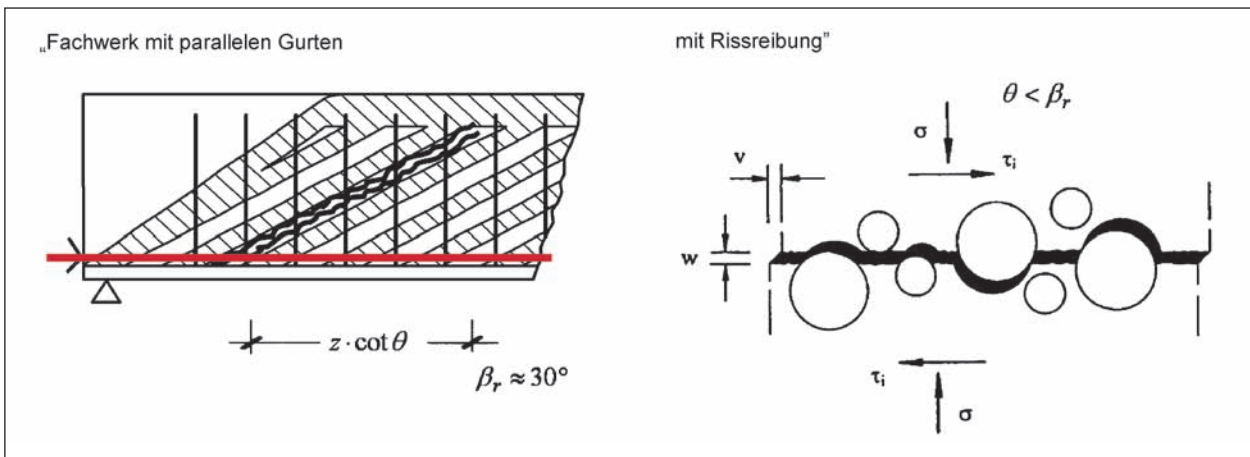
Mechanisches Modell der Querkrafttragfähigkeit für Spannbeton (DIN – FB 102): „Parallelgurtiges Fachwerk mit Rissreibung“
